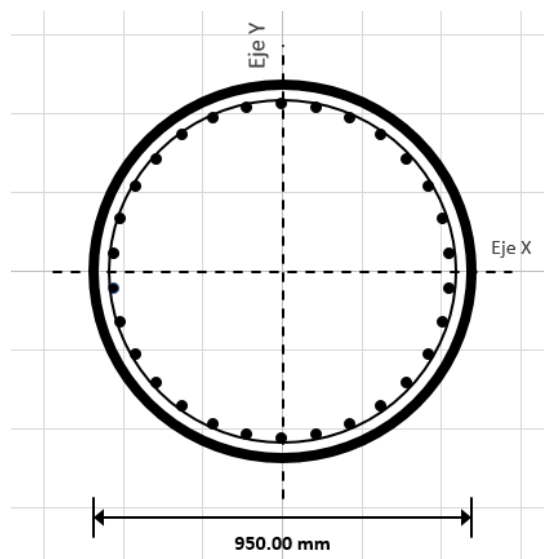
Vista esquemática de la sección. (Fuente autoría propia, 2019)
